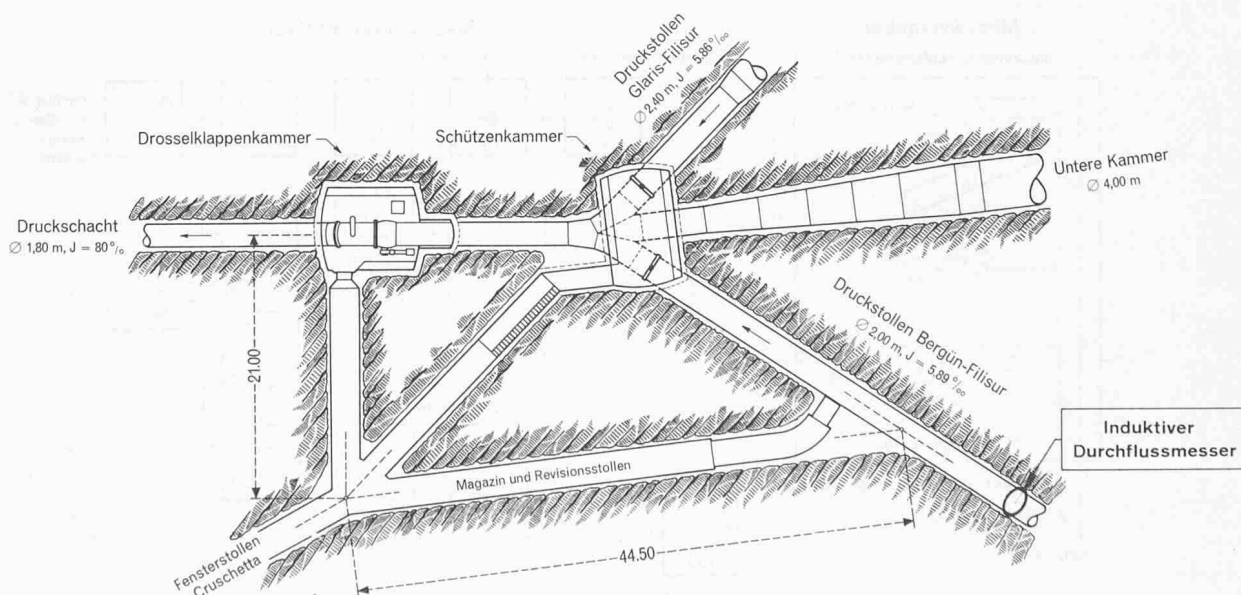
Wasserschloss Cruschetta, Grundriss 1:600
